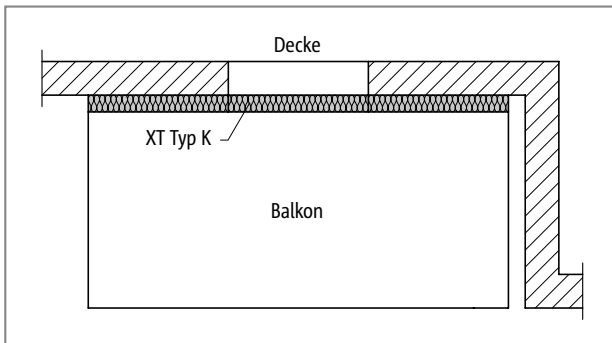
Schöck Isokorb® XT Typ K: Grundriss
